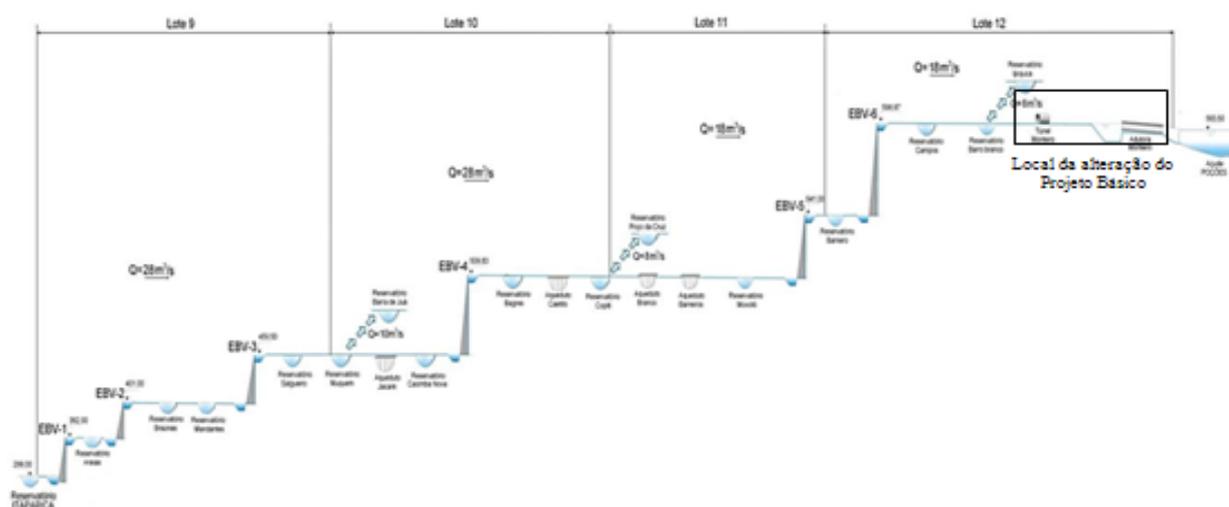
Perfil esquemático com a localização do trecho da proposta de alteração do PISF
